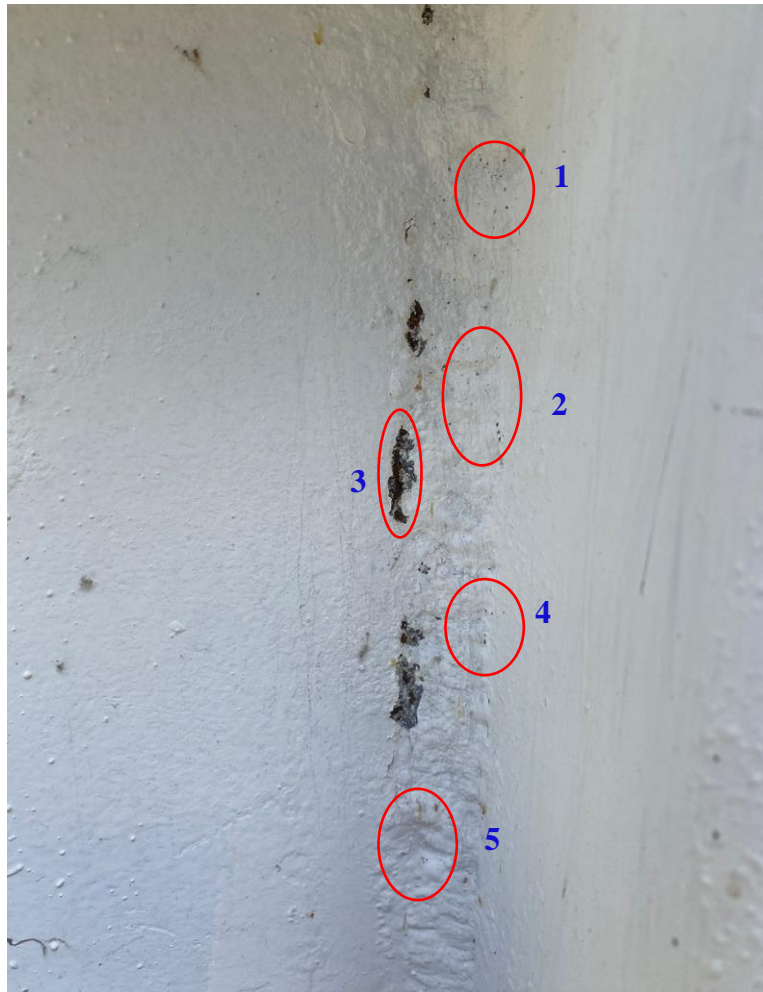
62: Discontinuidades en el cordón de soldadura de la conexión viga – columna
